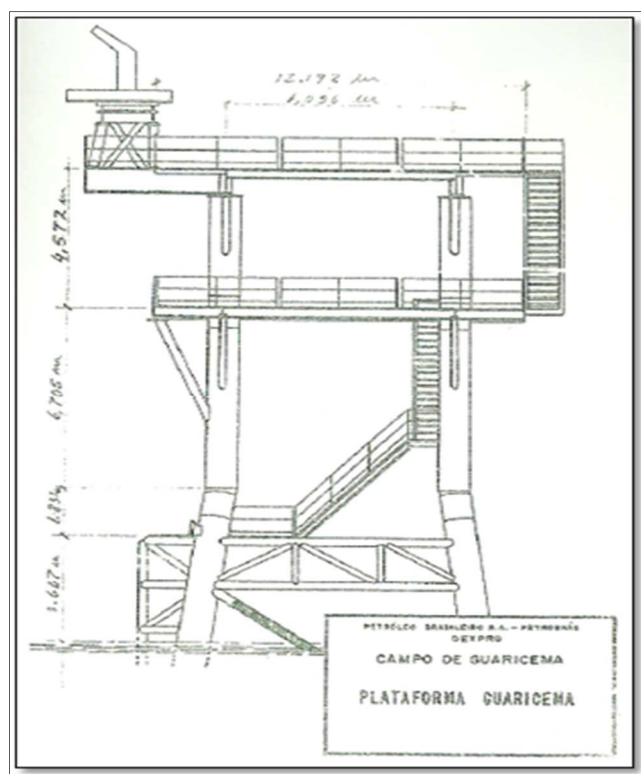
Planta da jaqueta do campo de Guaricema final da década de 1960. Fonte: Livro Escola de Terra e Mar (2009, p.136)
